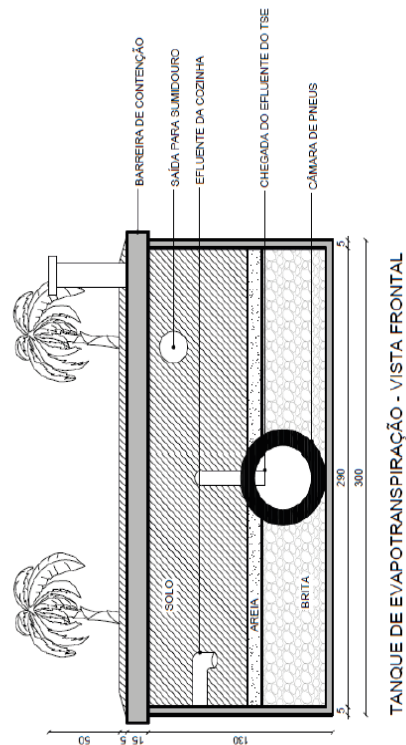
Planta em corte frontal do tanque de evapotranspiração.
